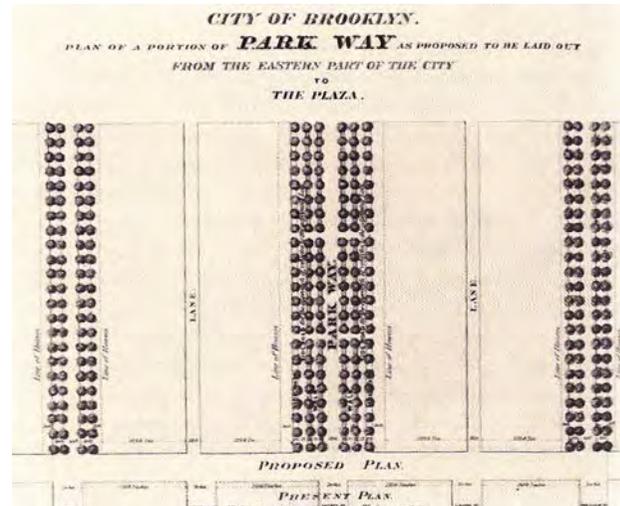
Planta tipo da Eastern parkway, Brooklyn, 1868.
